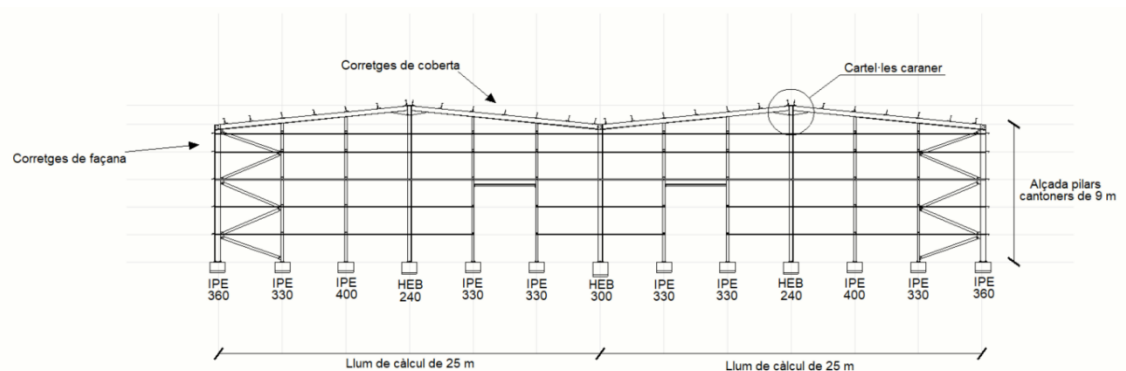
Detall general de l'estructura del pòrtic tester. També s'observen les corretges de façana i coberta, i el travat de façana (Font: Tekla Structures)
